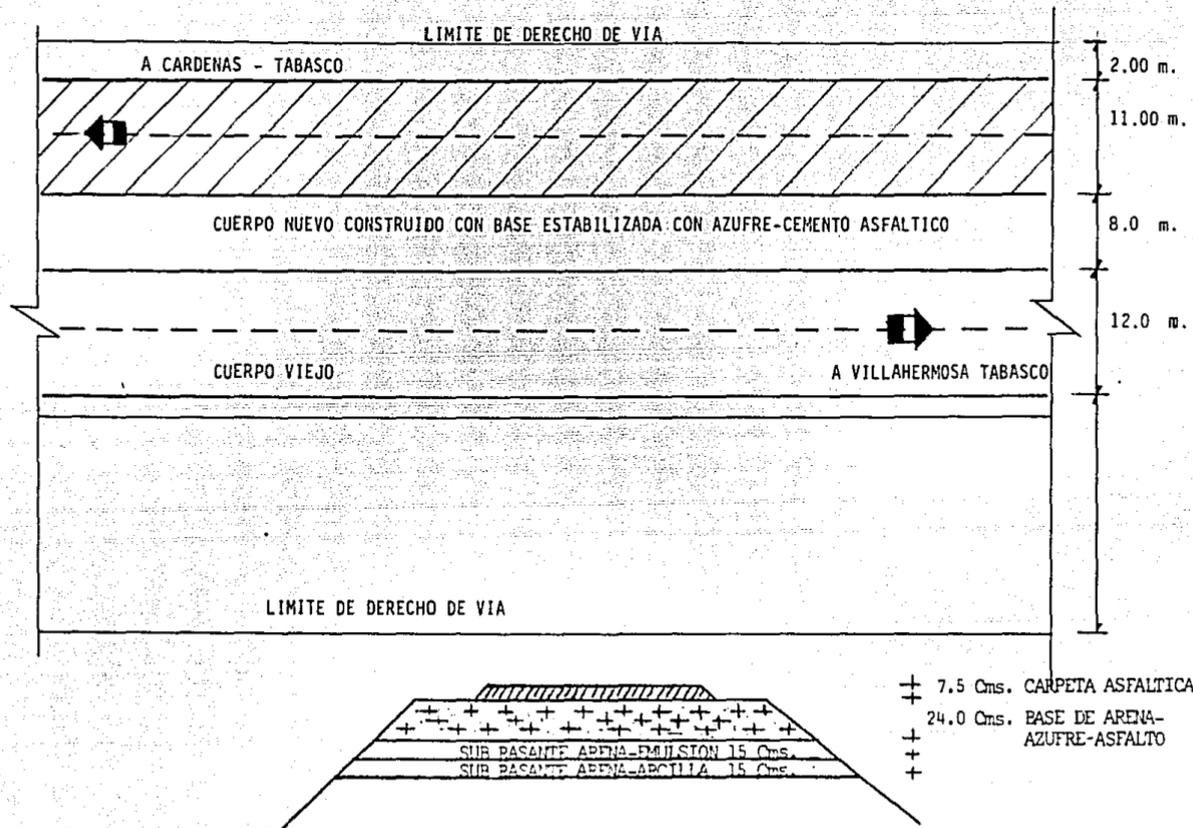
PLANTA Y SECCION TRANSVERSAL DEL TRAMO
